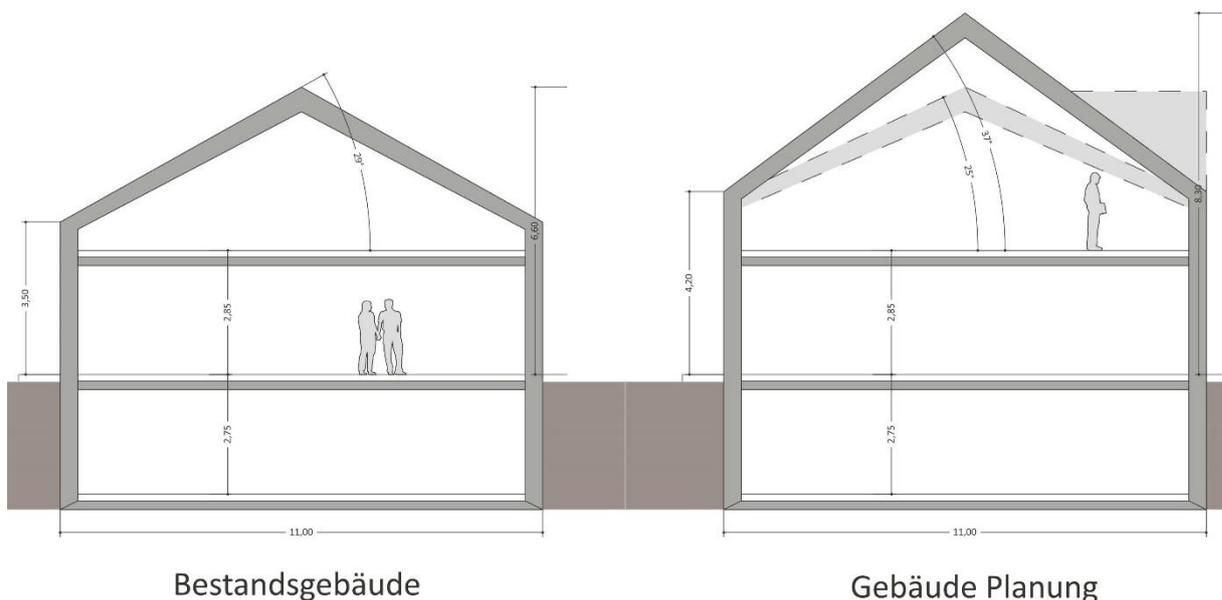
Gebäudeschnitte durch Bestandsgebäude (Mittelmaß aus bestehenden Gebäuden der Lindenstraße) und Gebäude Planung (schematische Darstellung)
